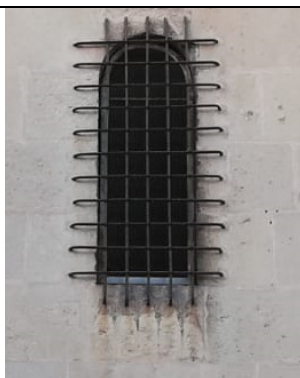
Manchas de óxido. Verja ventana fachada Sur (1)
